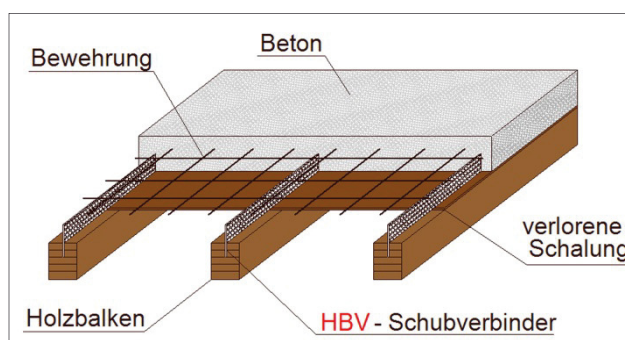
HBV-Schubverbinder³ (Einbau längs zur Spannrichtung in Holz-Beton-Verbunddecken)
